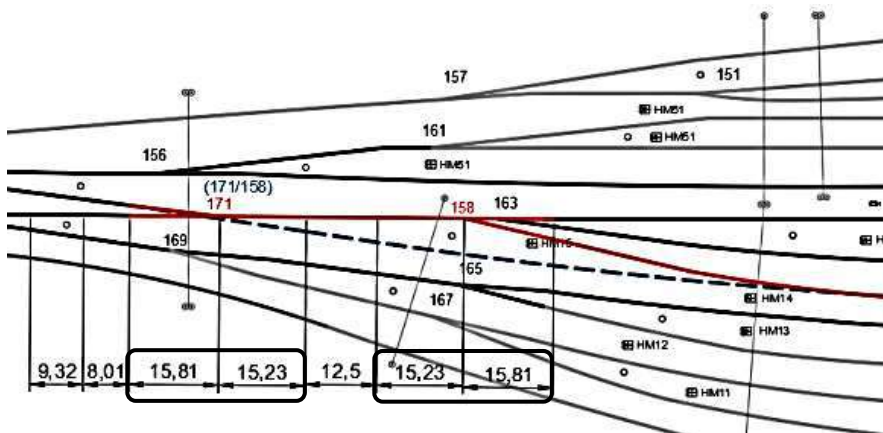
Схема укладки стрелочных переводов № 171 и № 158 взамен перекрестного стрелочного перевода
